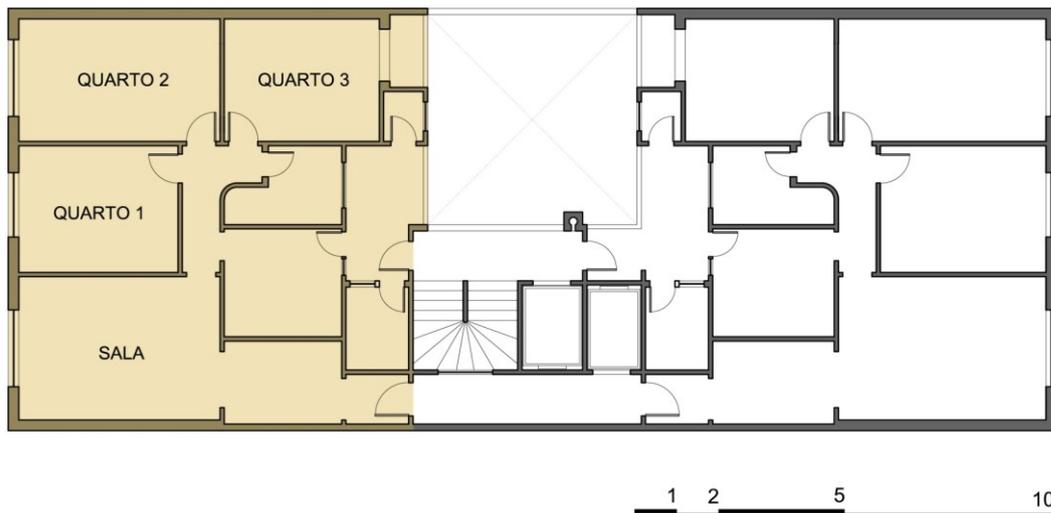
Planta Baixa do Pavimento Tipo do edifício Rua Aires Saldanha, 34 – indicação do apartamento adotado como modelo (fonte: Concepção Autor e Desenho Foidelli).
